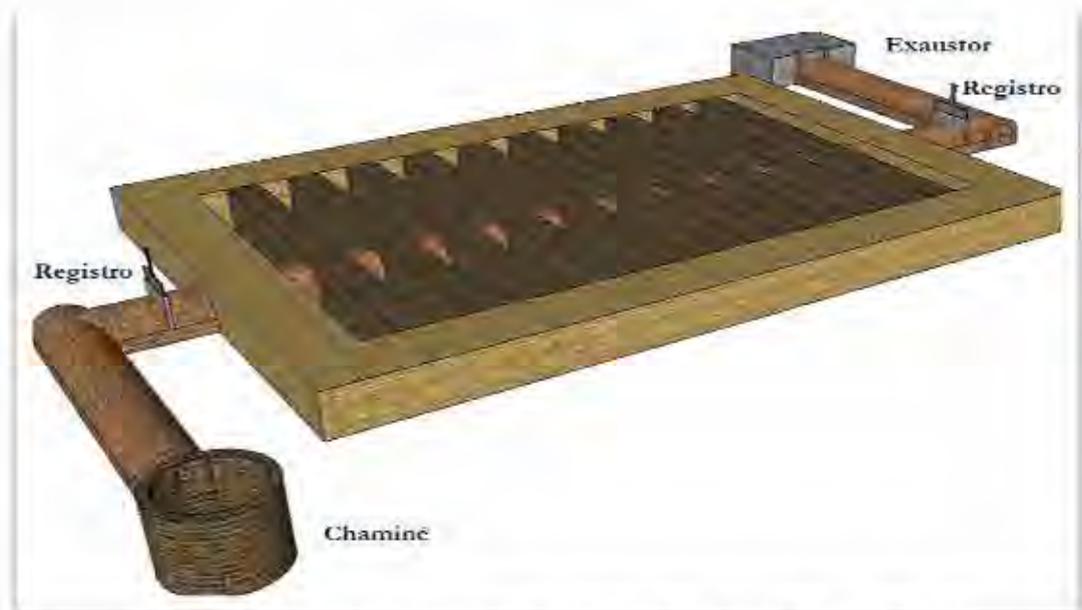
Ligação dos canais com a estufa e com a chaminé. Fonte: Autor.
